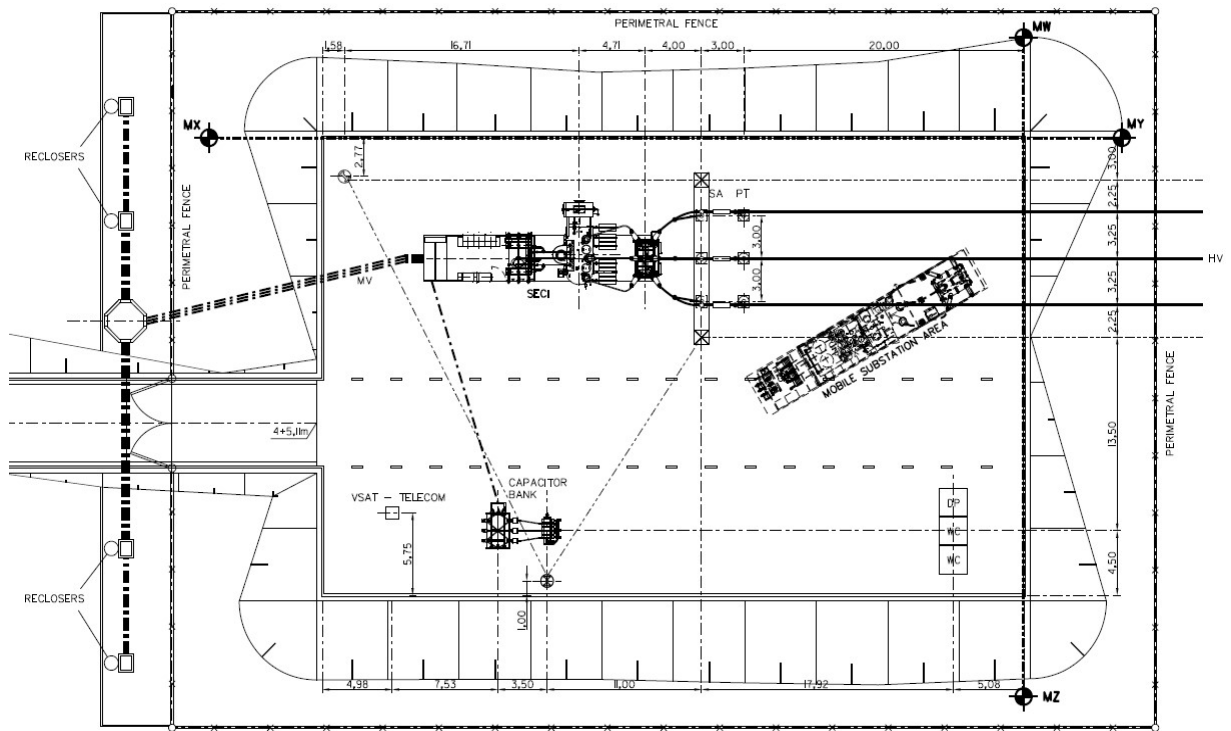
Layout de Projeto SECI 138-13,8KV – 15MVA
